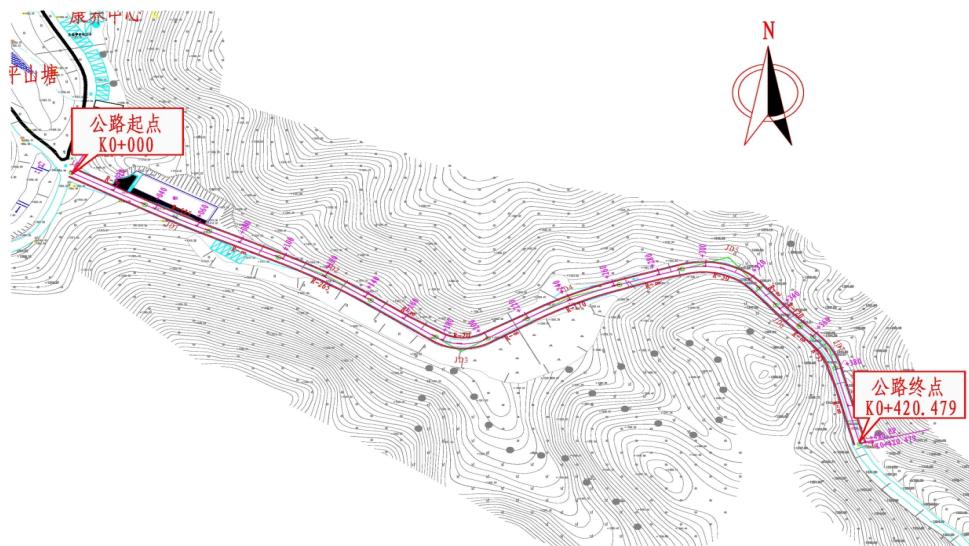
雪峰山森林公园（坪山塘）公路平面图
